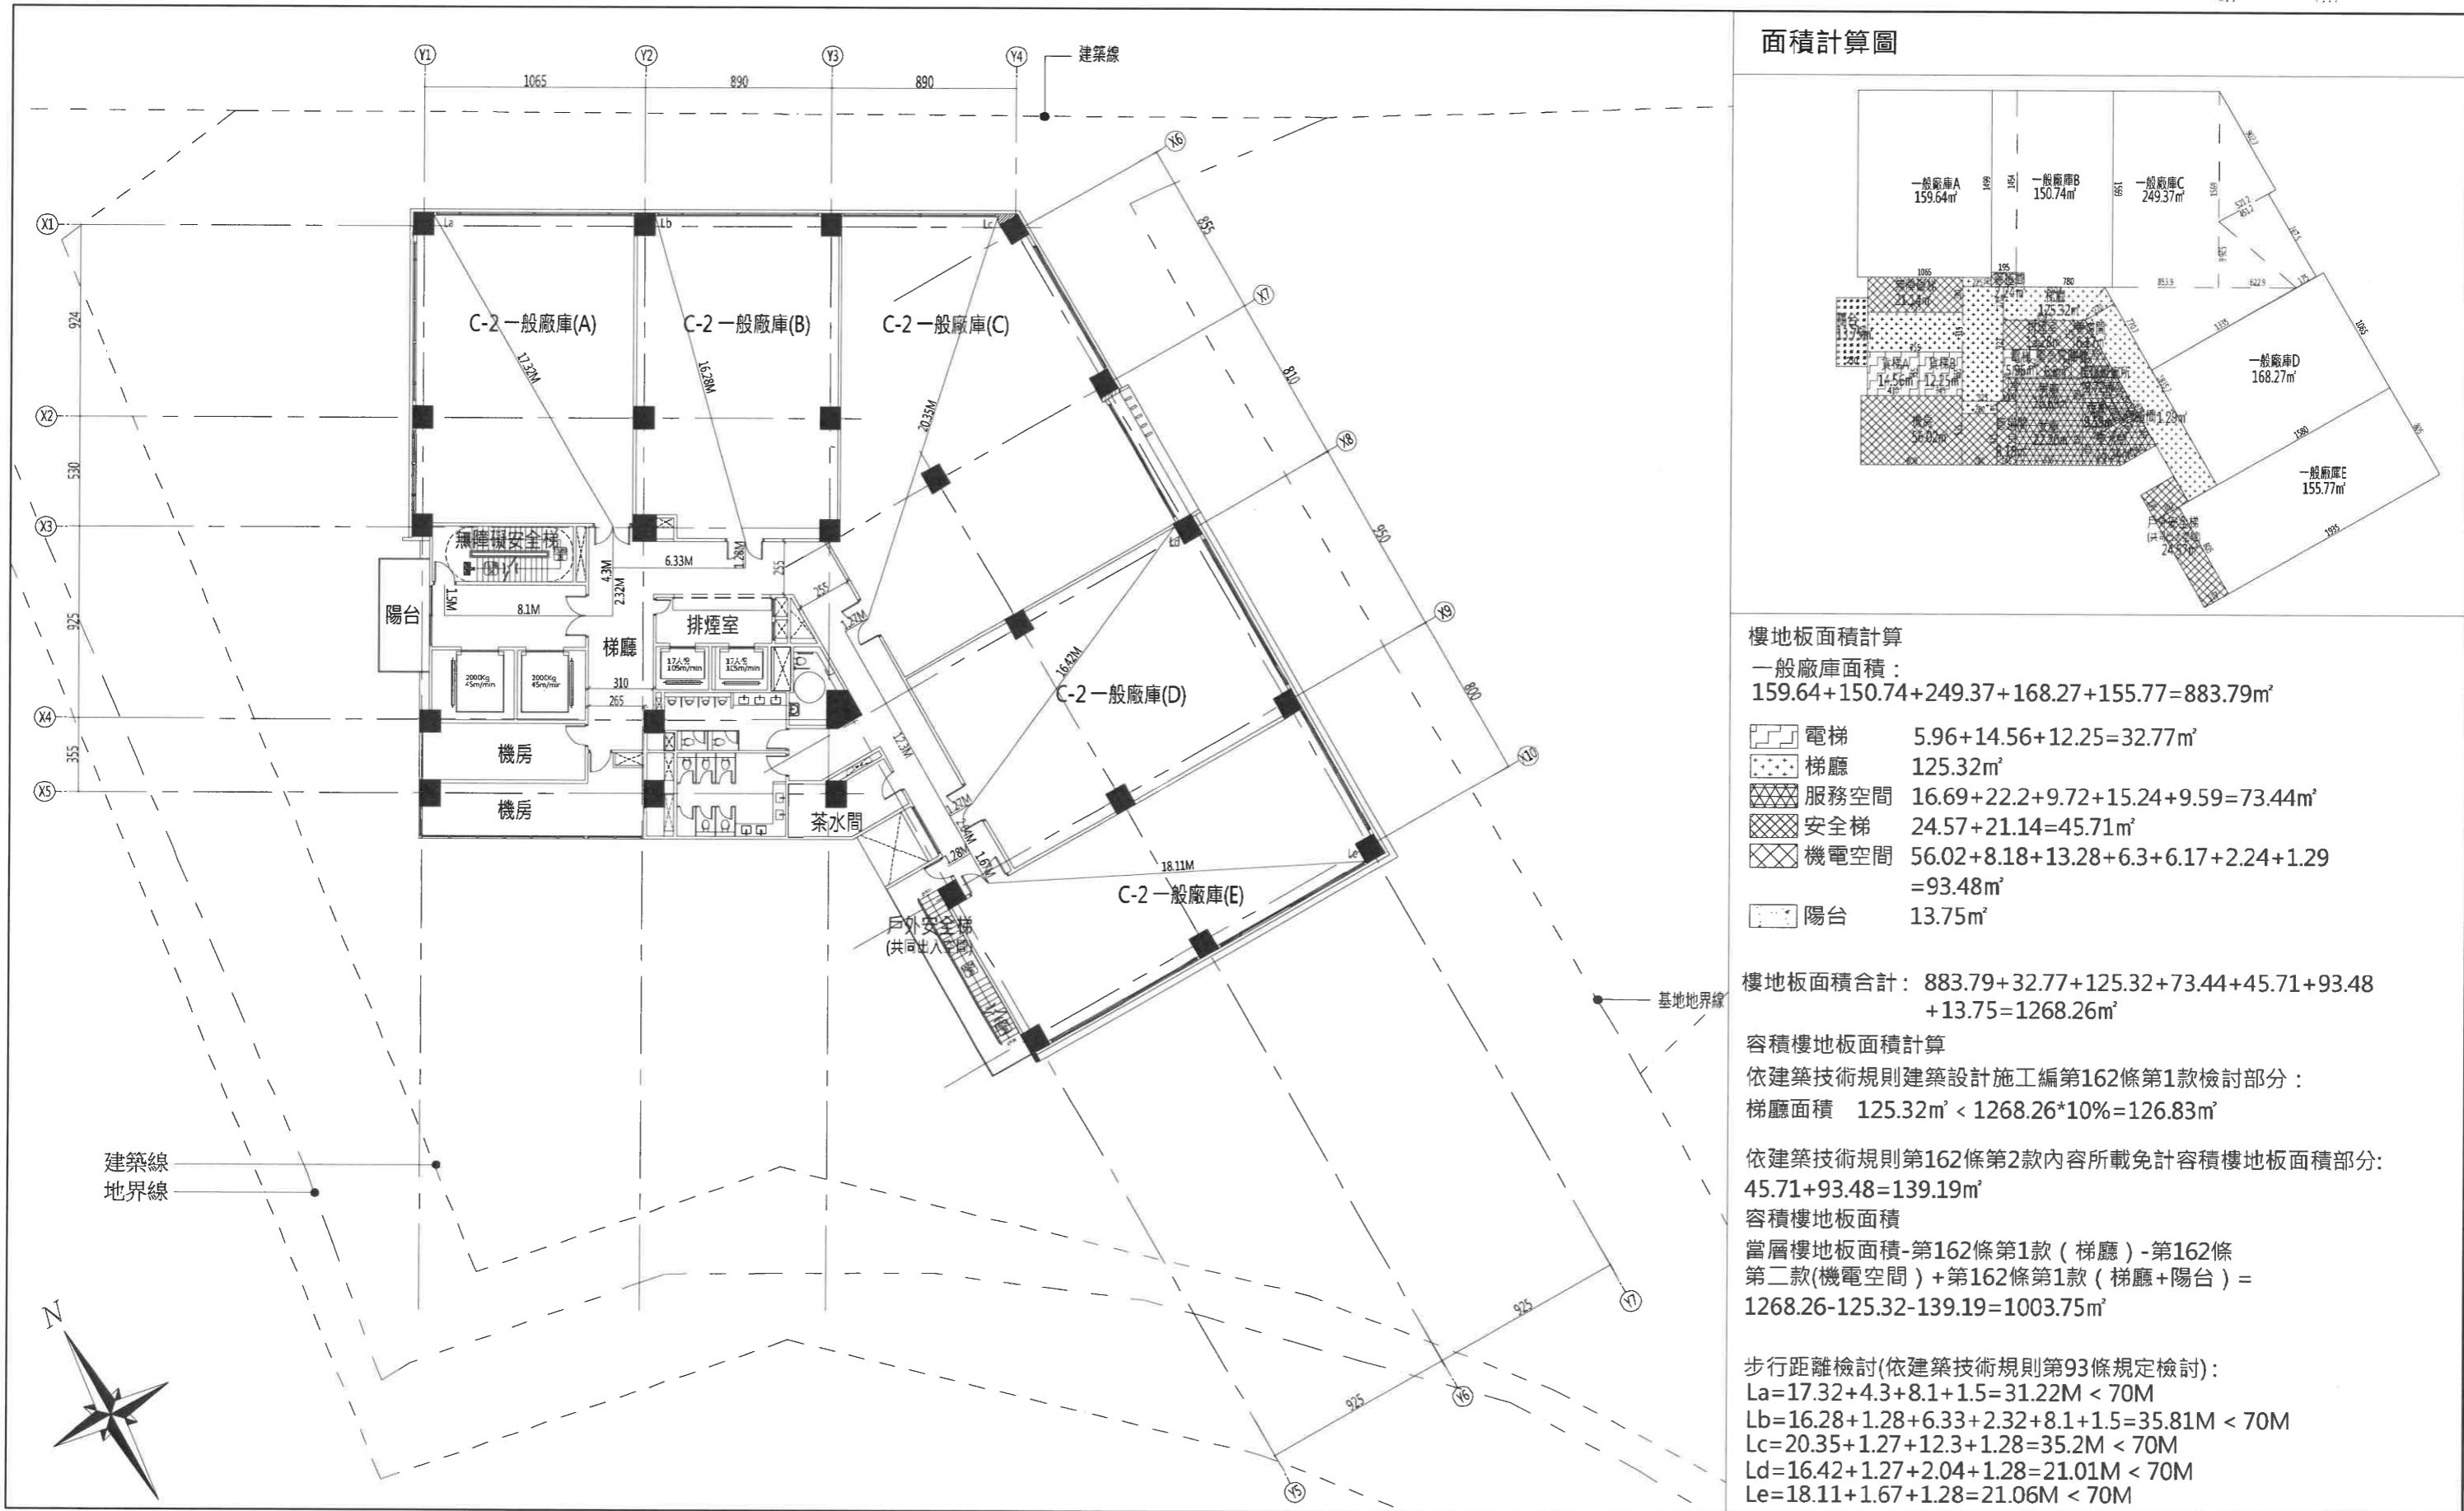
地上七層平面圖(原核定)(S : 1/300)
